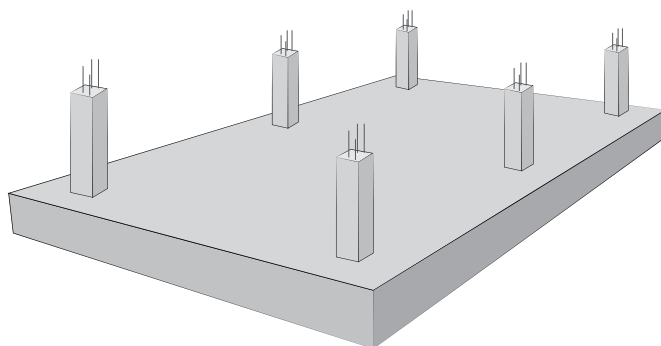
Ilustração de um *radier* em detalhe pilaretes.
